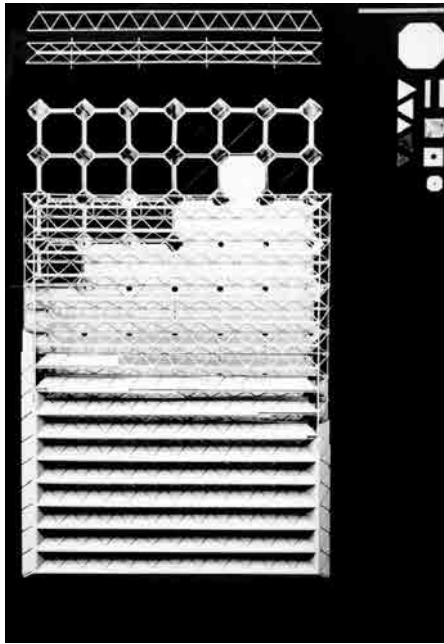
Desarrollo de componentes prefabricados para la construcción de pabellones industriales en hormigón (Desarrollo de un sistema de prefabricación con curado al vapor financiado por la empresa Kellerbau Süssen). Departamento de Construcción. 2º año de estudio, curso 60/61. Estudiantes: Karl-Heinz Allgayer, Gerhard Curdes y Renate Grünwald. Profesor: R. Doernach. (Curdes 2001)
